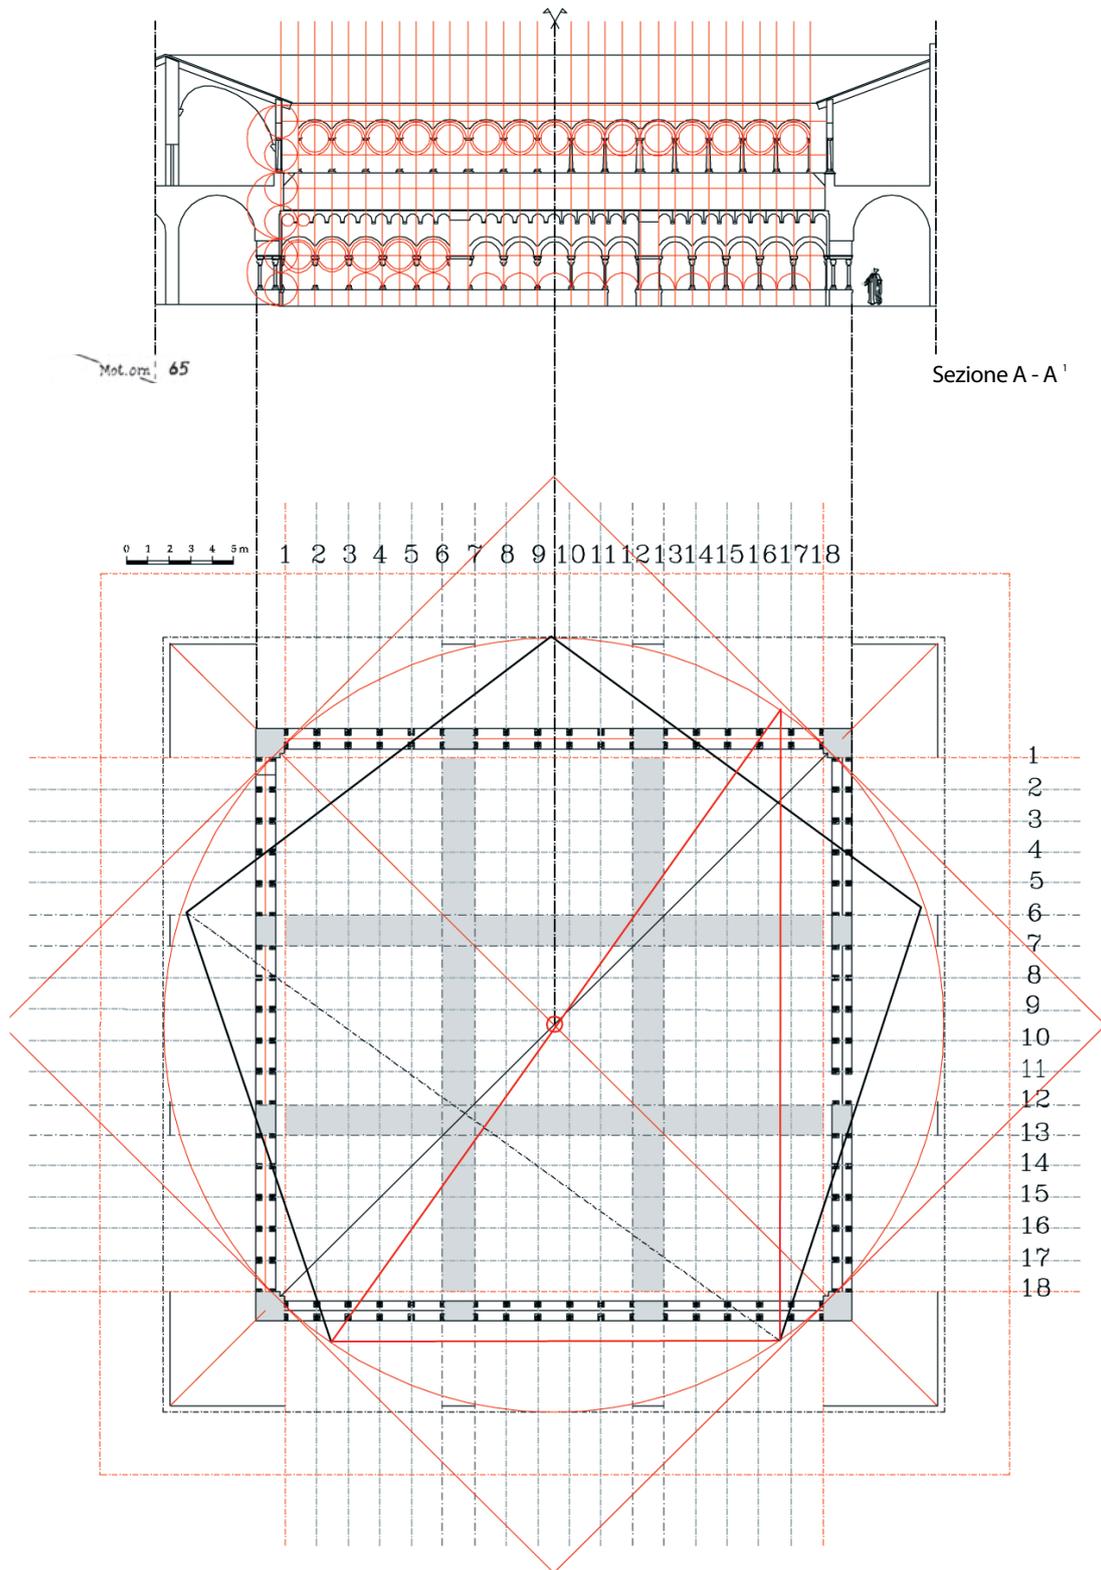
Il modello ideale: pianta e prospetto-sezione del chiostro di Sant Cugat.
